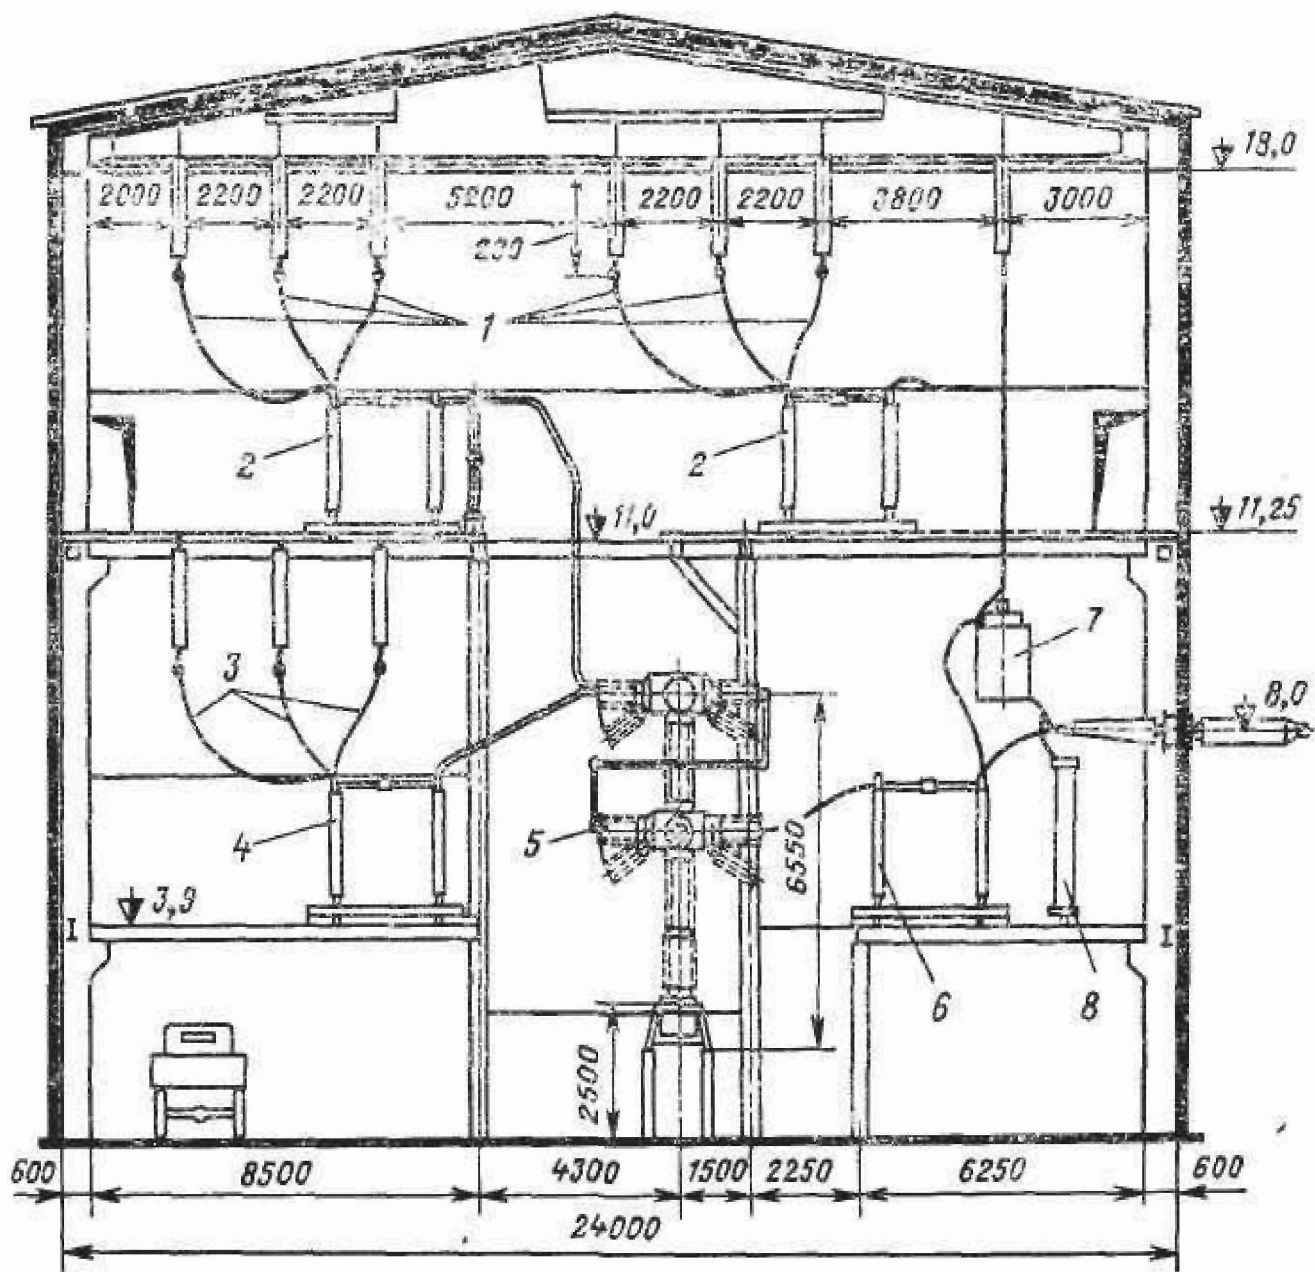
ЗРУ 220 кВ с двумя рабочими и обходной системами шин. Разрез по ячейке линии: 1 – рабочие системы шин; 2 – шинный разъединитель; 3 – обходная система шин; 4 – обходной разъединитель; 5 – выключатель; 6 – линейный разъединитель; 7 – ВЧ заградитель; 8 – конденсатор связи
